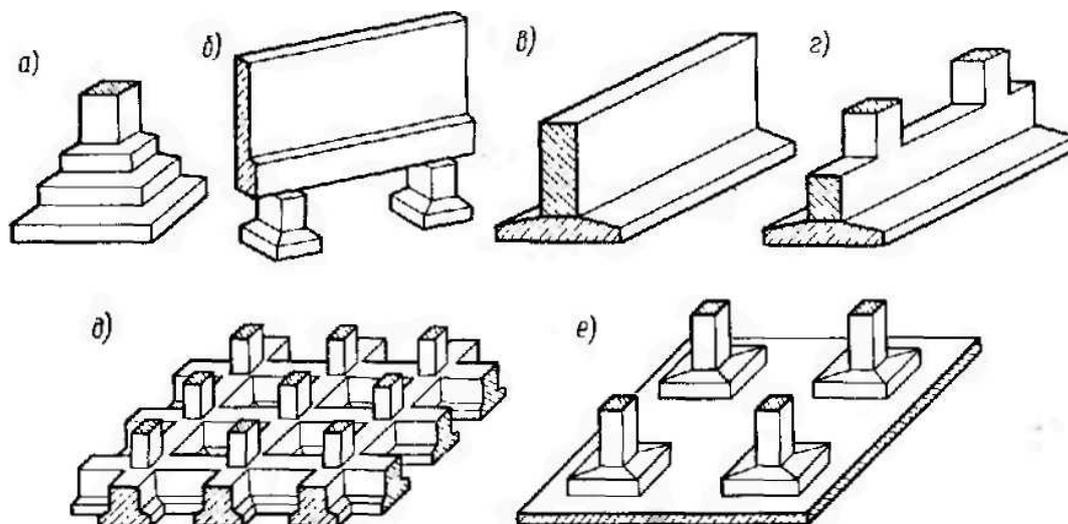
Основные типы фундаментов мелкого заложения:
